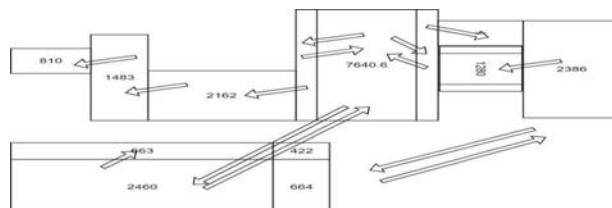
主要屋面群施工资源调度方向示意图(工程量: m²)
